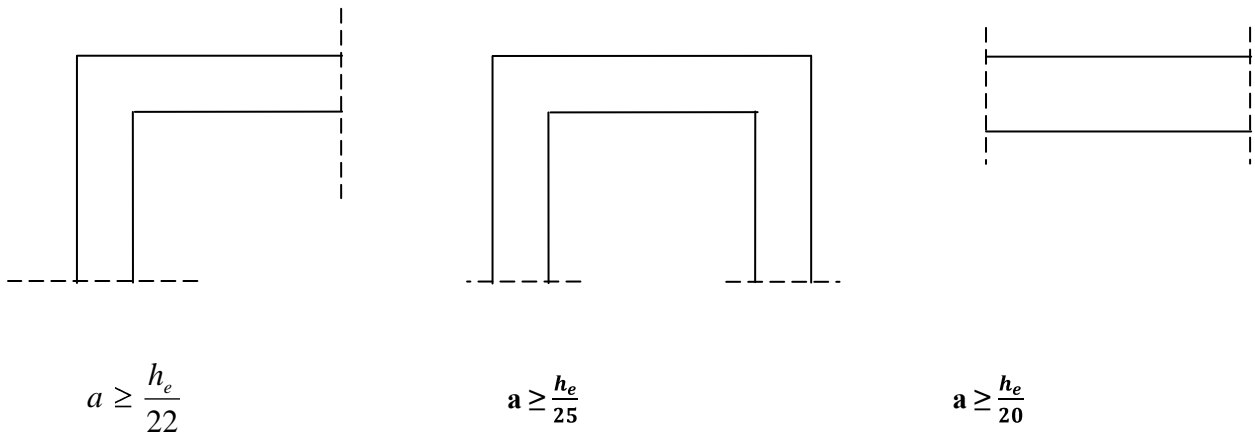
coupe du voile en plan selon les conditions de rigidité à l'extrémité.
